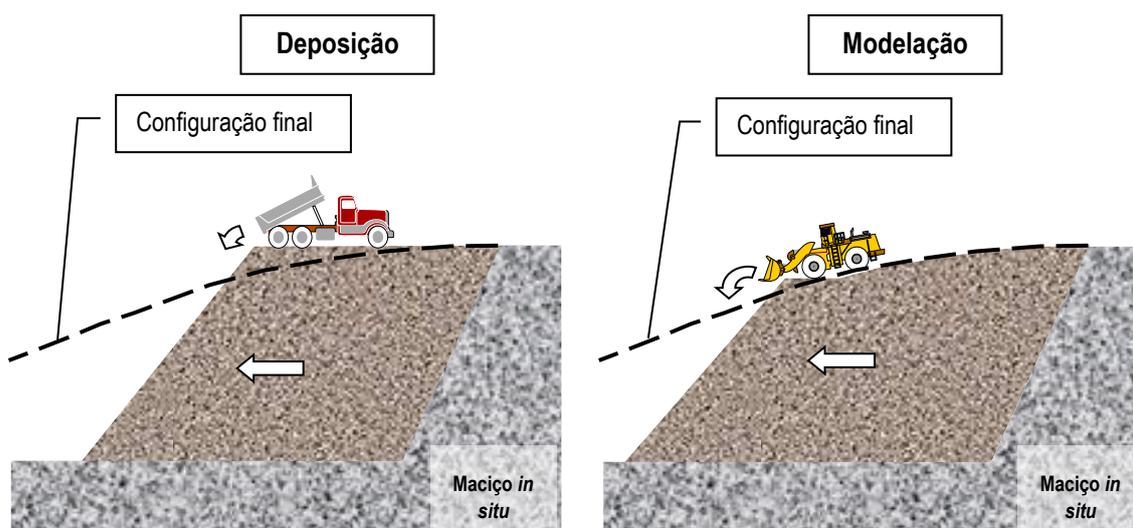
Perfil esquemático do método construtivo para o preenchimento dos vazios de escavação.
